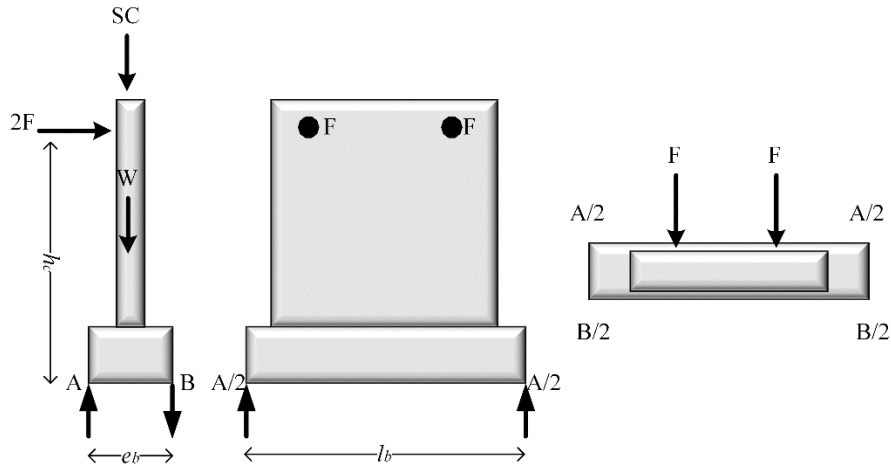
Vista frontal y en plata del muro ensayado y distribución de esfuerzo en la losa de reacción.
